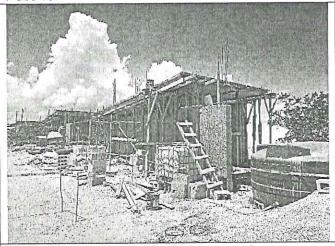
Al momento se observan dos construcciones "privado" con techo a desnivel elevado.
